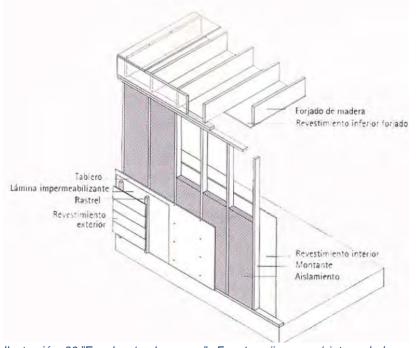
"Envolvente de muros". Fuente: viissa.com/sistema-baloon-frame
